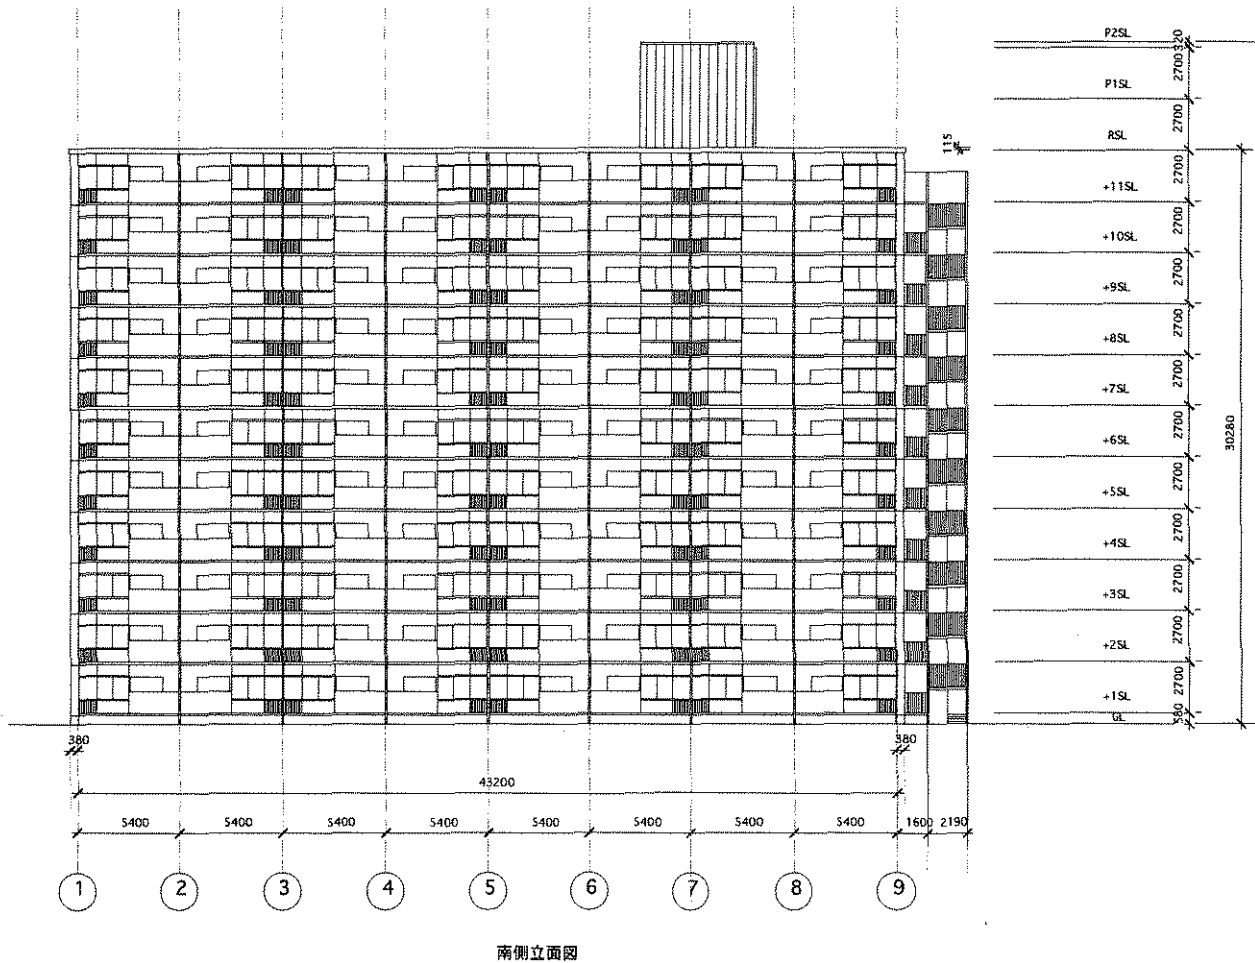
郊外型モデルの既存建物立面図(縮尺: 1/400)
